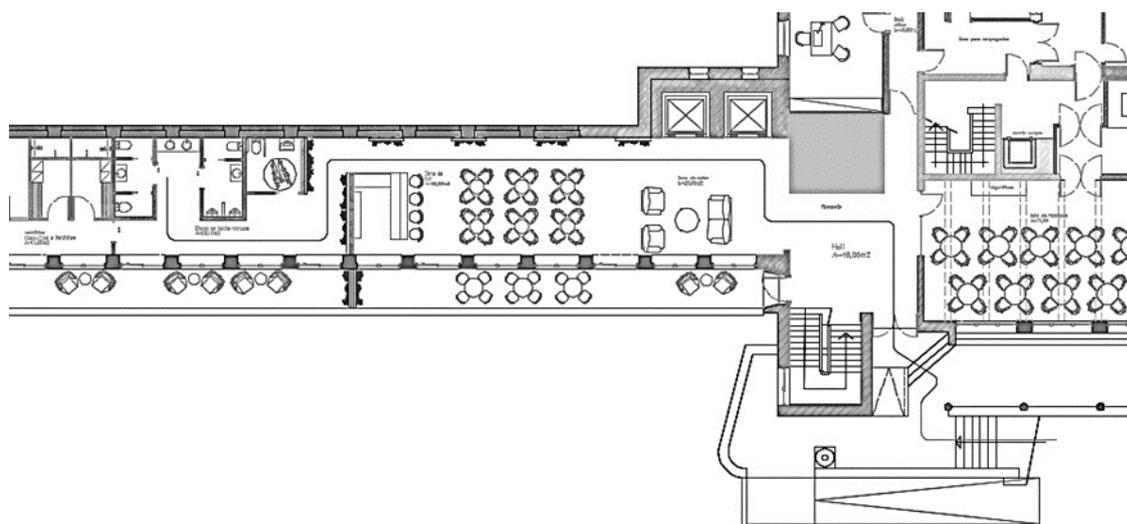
Planta de proposta - pormenor área de circulação piso 0
